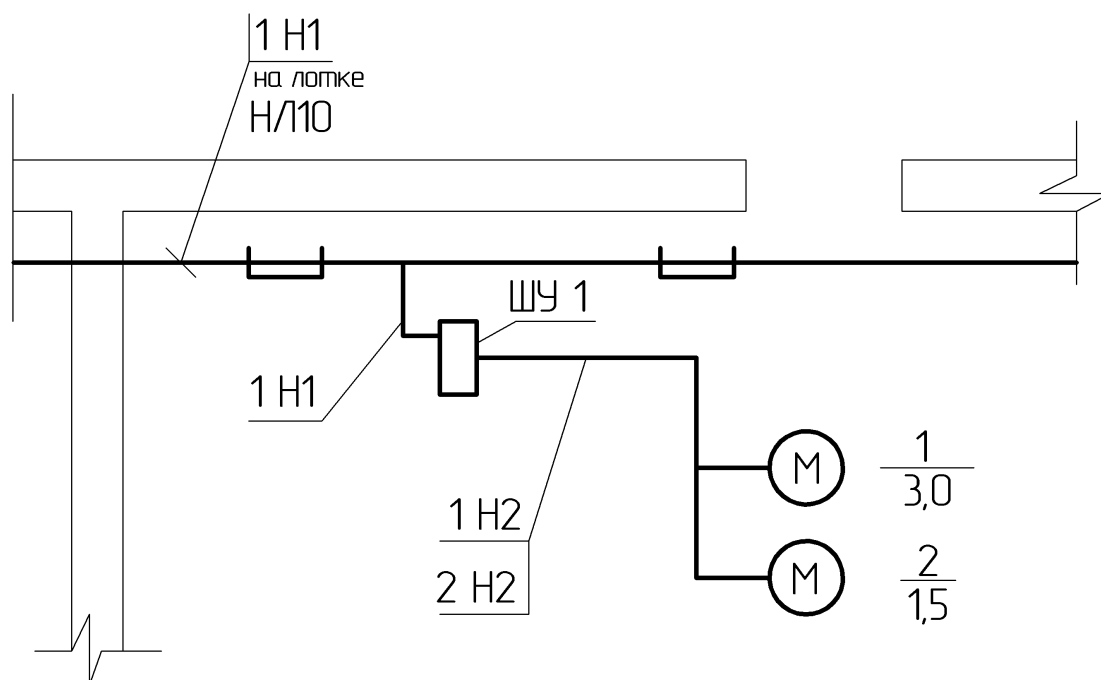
План расположения силового электрооборудования и электропроводок (см. приложение 3)
